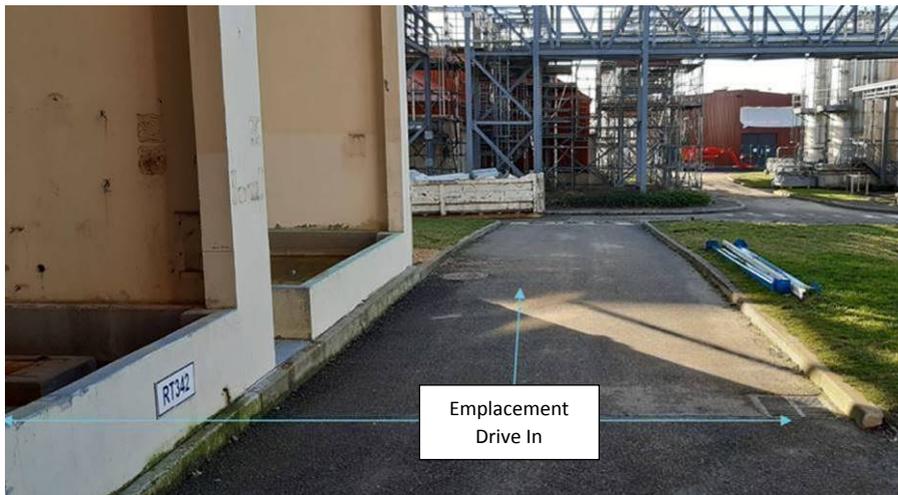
état actuel de la zone où sera construit le bâtiment Drive In.
